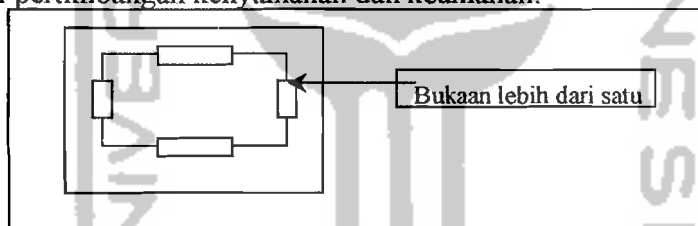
Elemen pembatas ruang pada langit-langit ruang pelatihan
